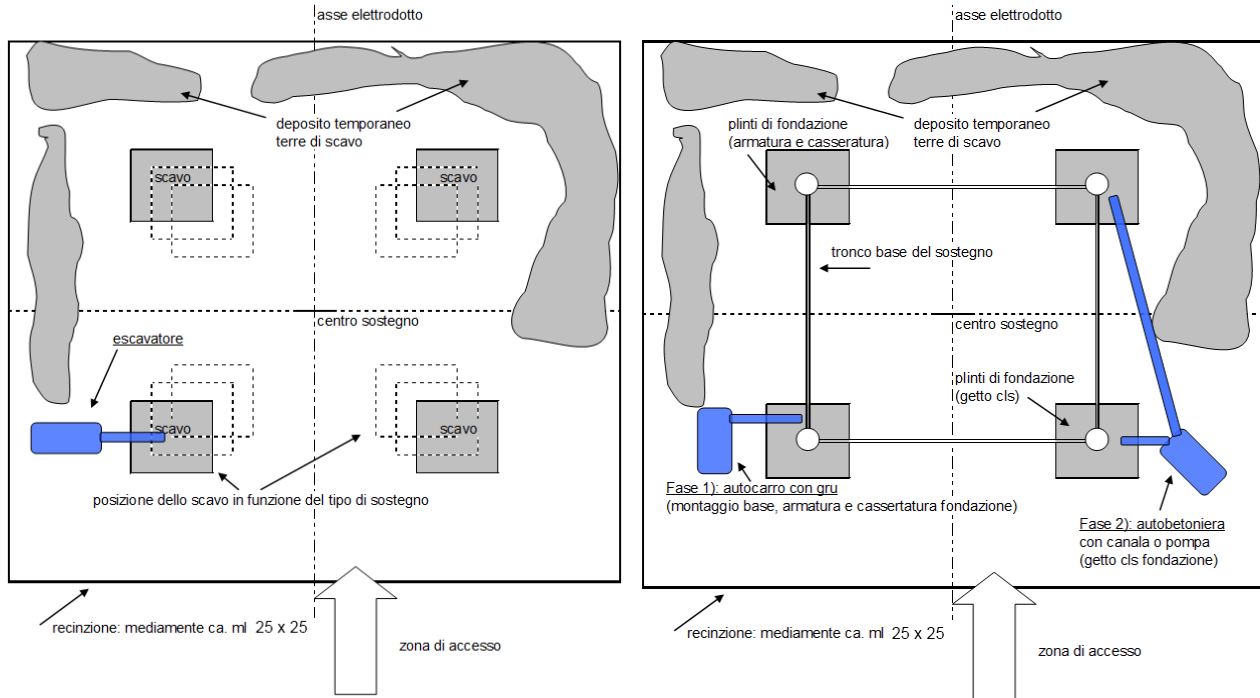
Planimetria dell'Area Sostegno (scavo di fondazione - getto e basi) - Tipologico
